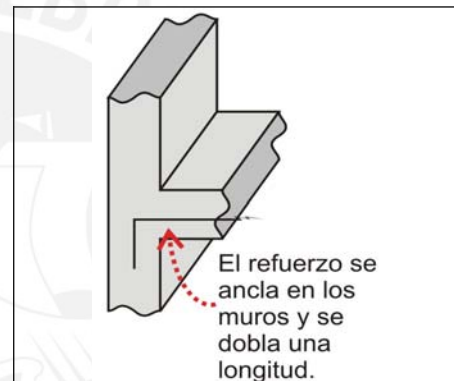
Anclaje de Acero Corrugado de Losas en Muros
